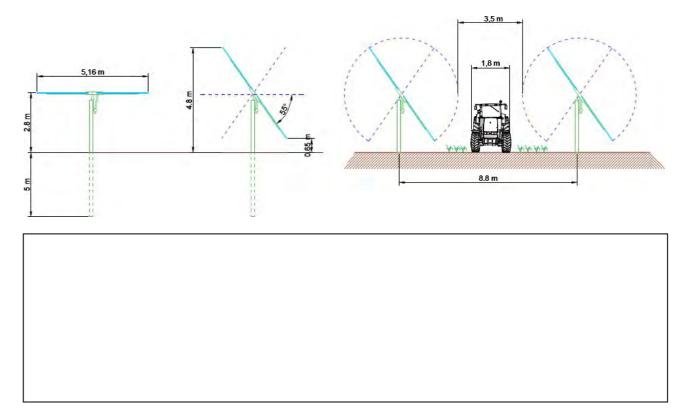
Progetto strutture – Allegato C\_049\_T\_27
